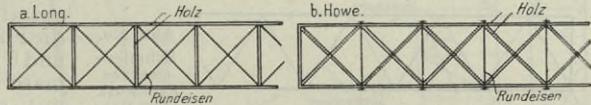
Hölzerne Fachwerke mit Eisen-Zugstangen.
